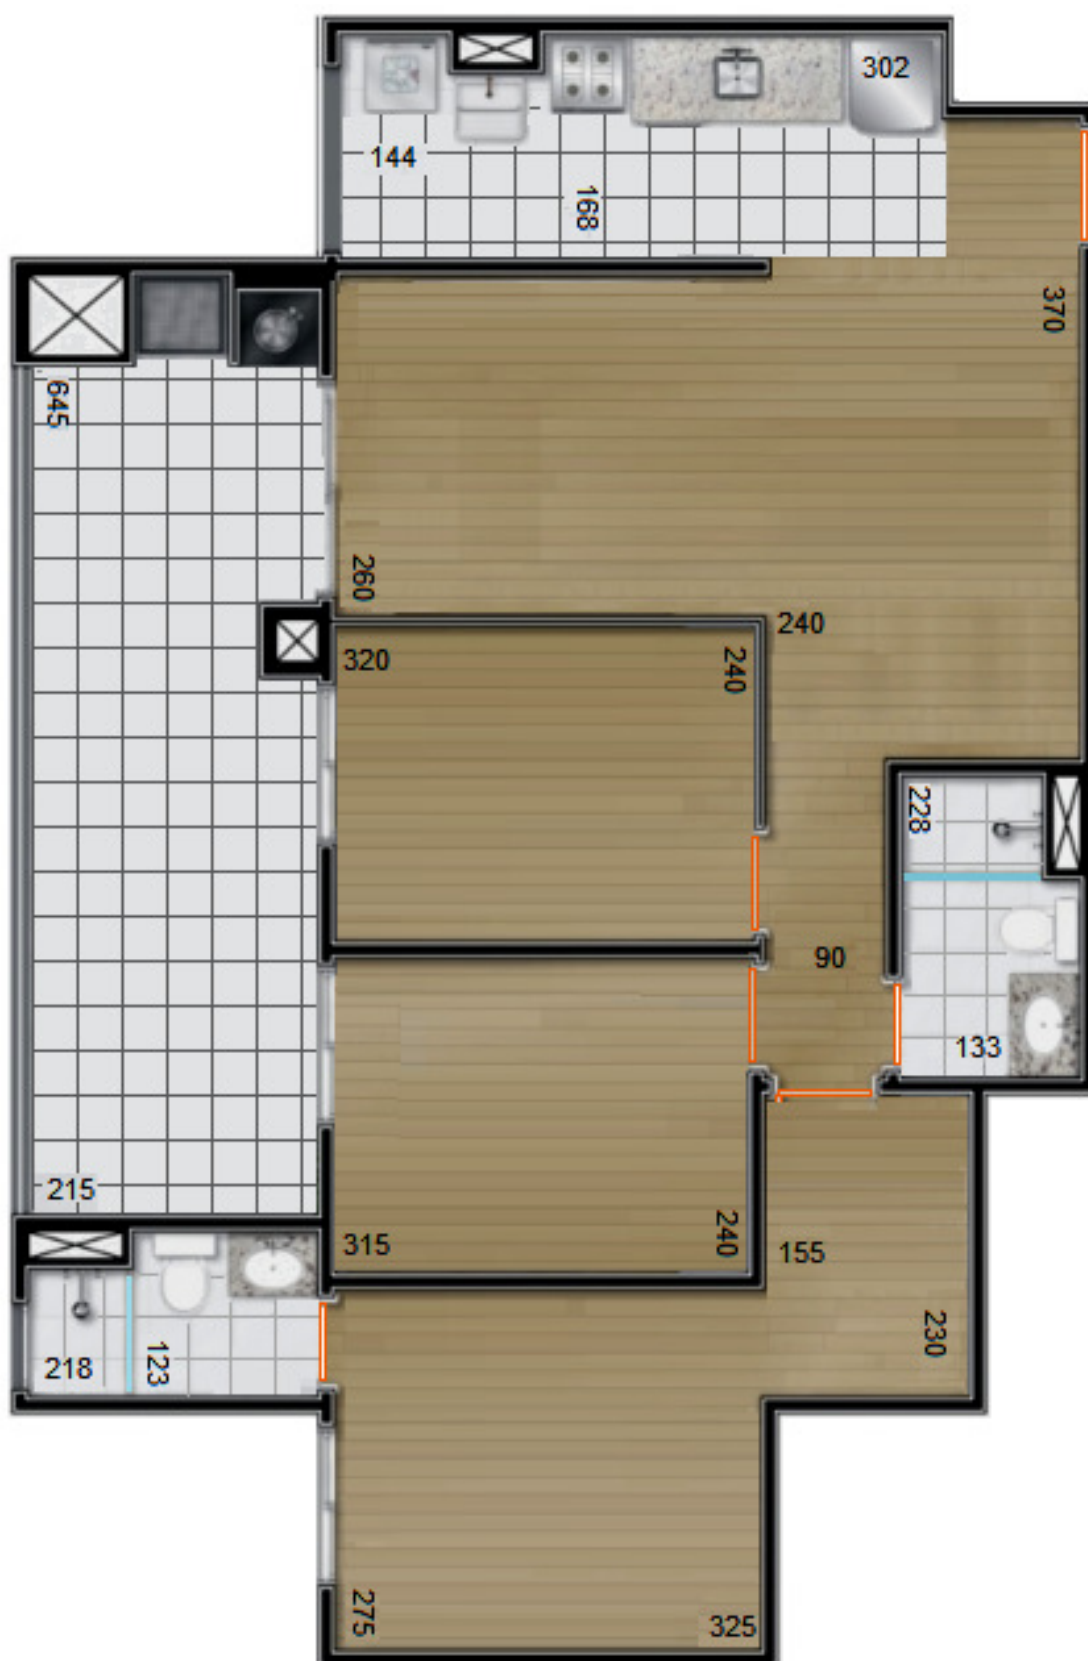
PLANTA DO APARTAMENTO “A” DE 476,3 m² PRIVATIVOS
